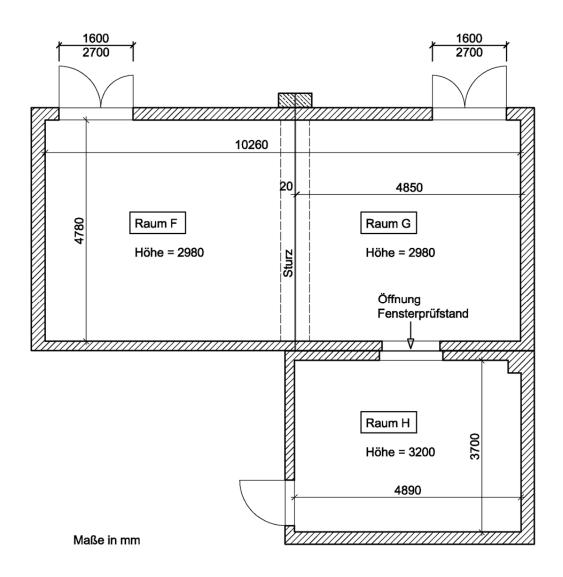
Grundriss des Fensterprüfstands.
